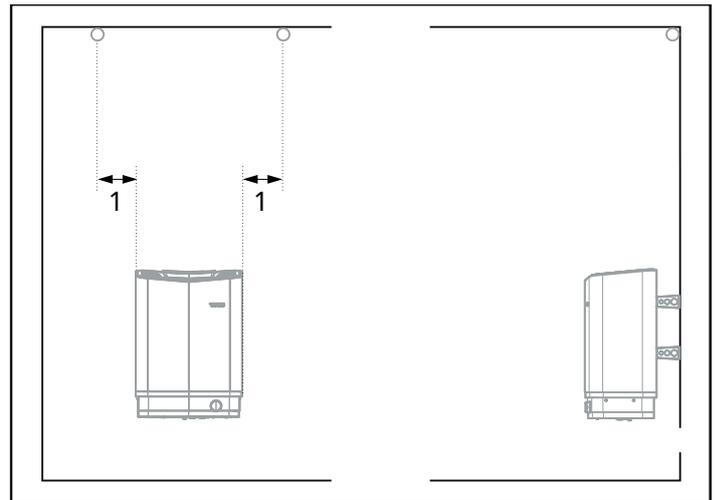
Installazione del sensore sul soffitto sulla linea centrale del riscaldatore visto dalla parte anteriore e laterale
